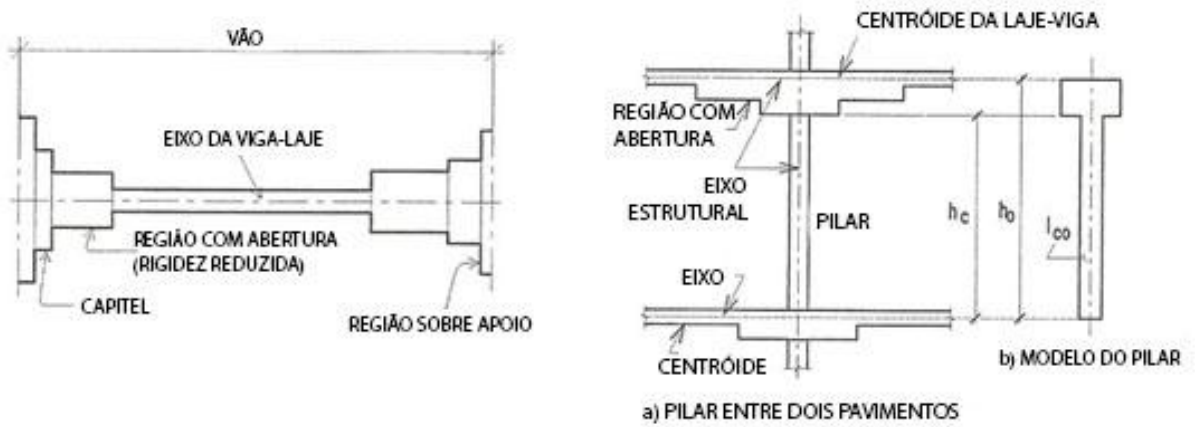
Esquemas da rigidez aproximada da viga-laje e do pilar (Adaptado de AALAMI & BOMMER, 1999).
